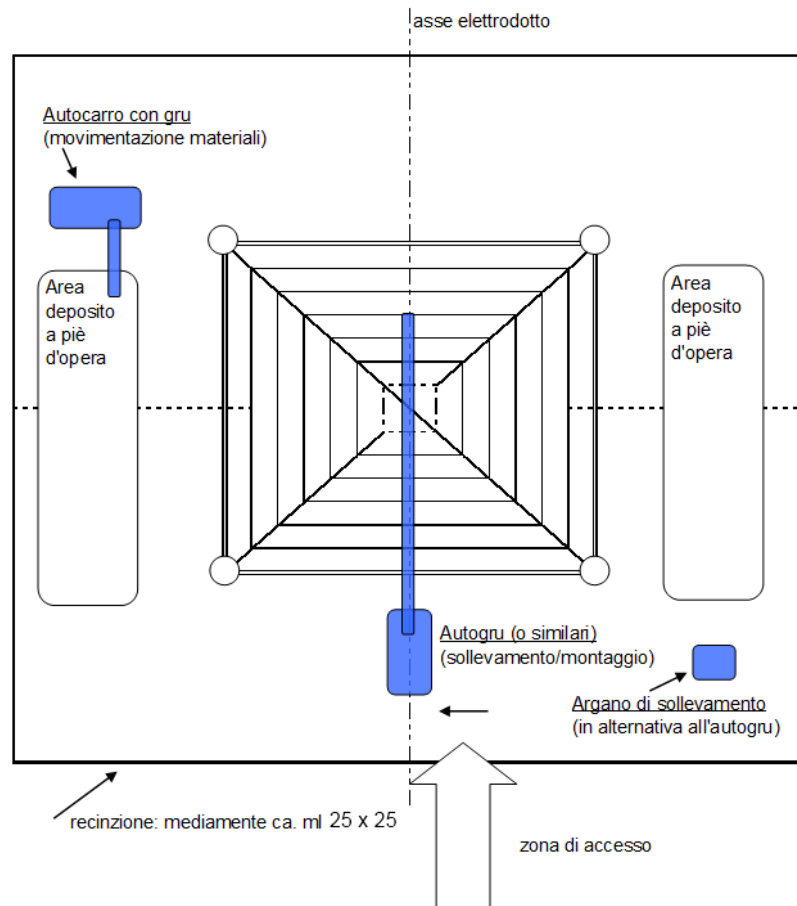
Planimetria dell'Area Sostegno (montaggio), tipologico
